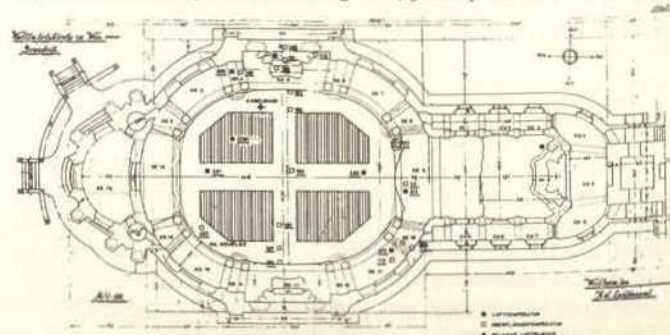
Lageplan der Meßstellen, Querschnitt ohne Maßstab
